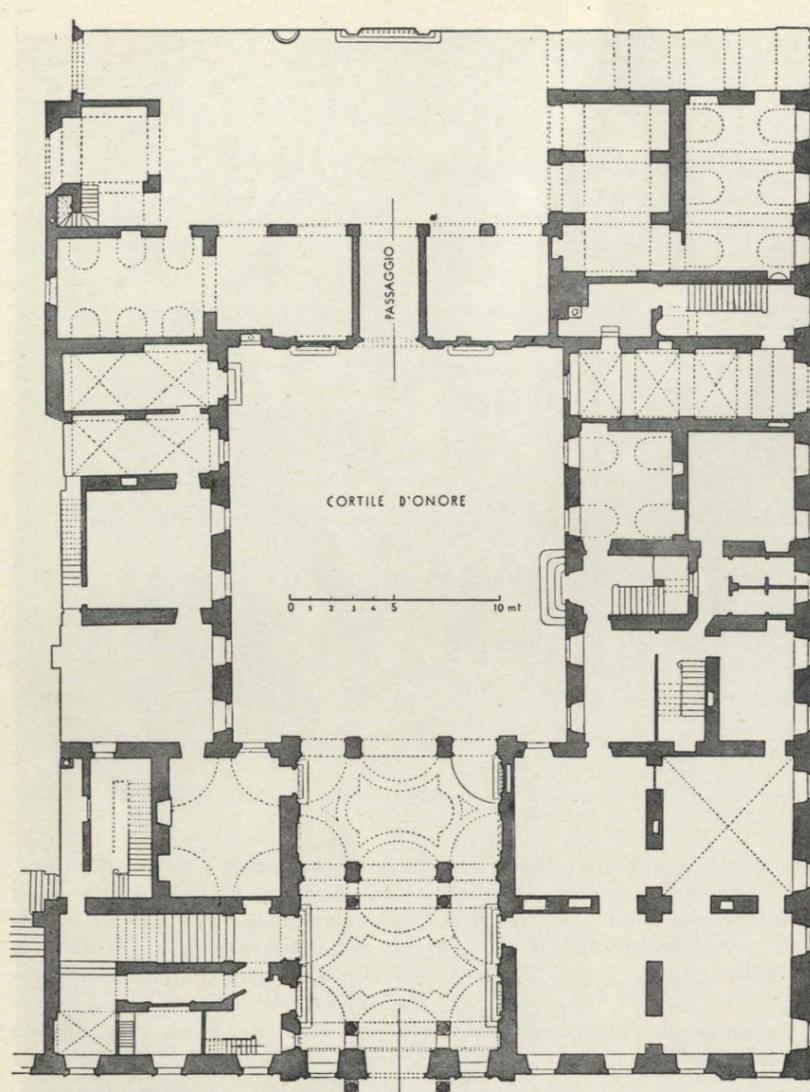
Planimetria del piano terreno, secondo un rilievo dell'ing. Olivero, del Palazzo Cavour (attualmente proprietà G. A. Carpano).
